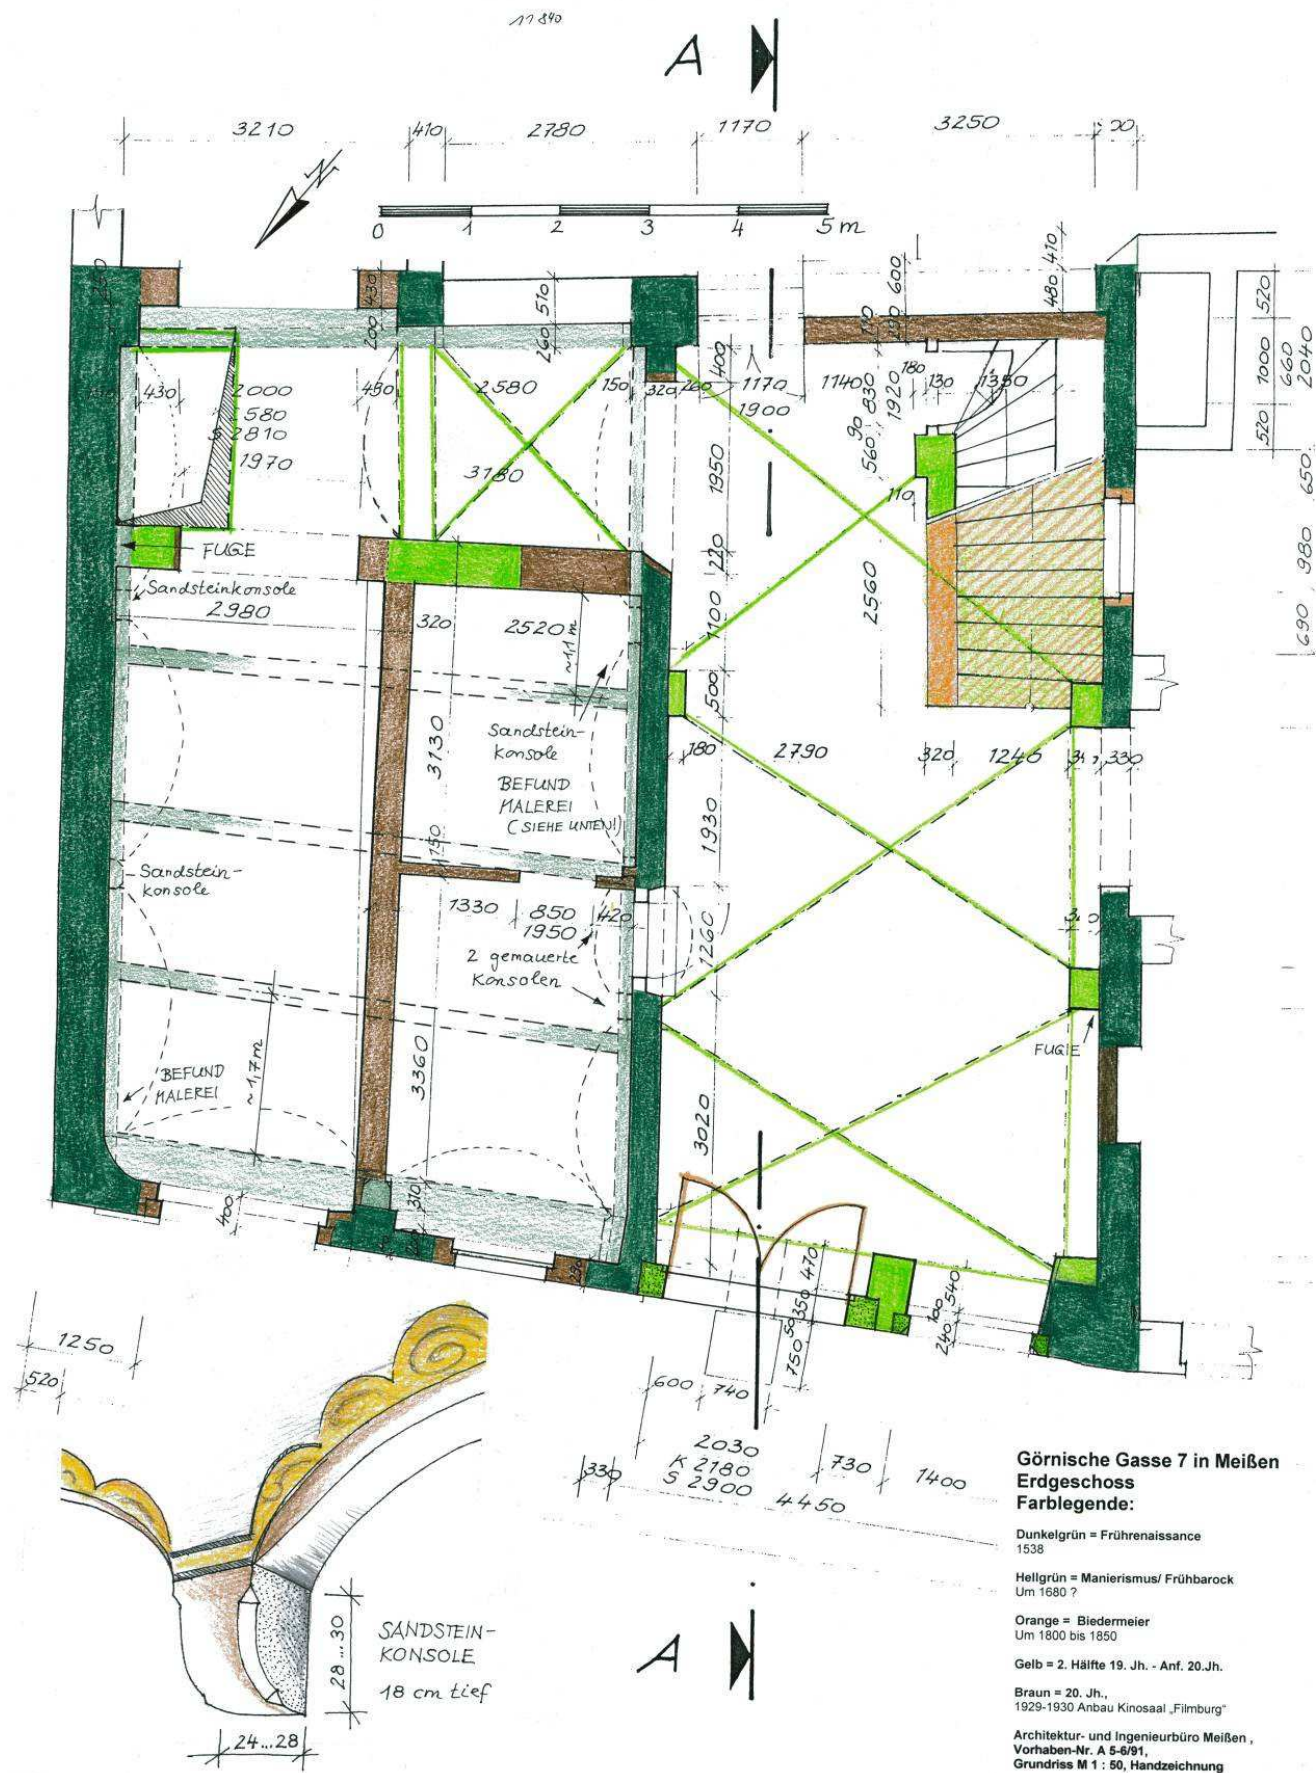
Görnische Gasse 7, Baualtersplan Erdgeschoss
